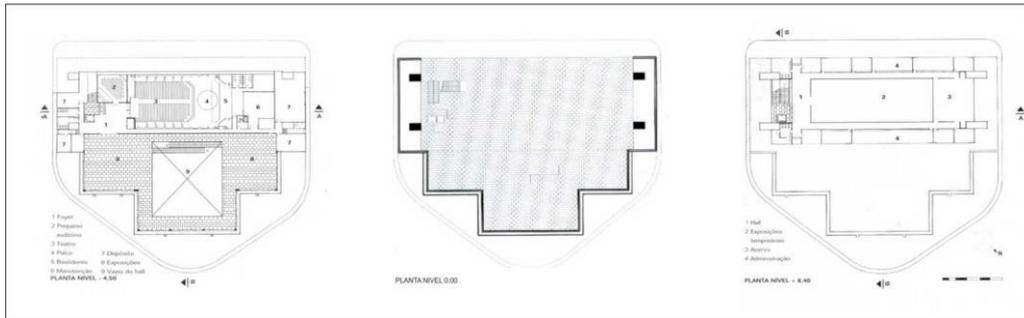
Plantas / Museo De Arte De São Paulo / Lina Bo Bardi.
